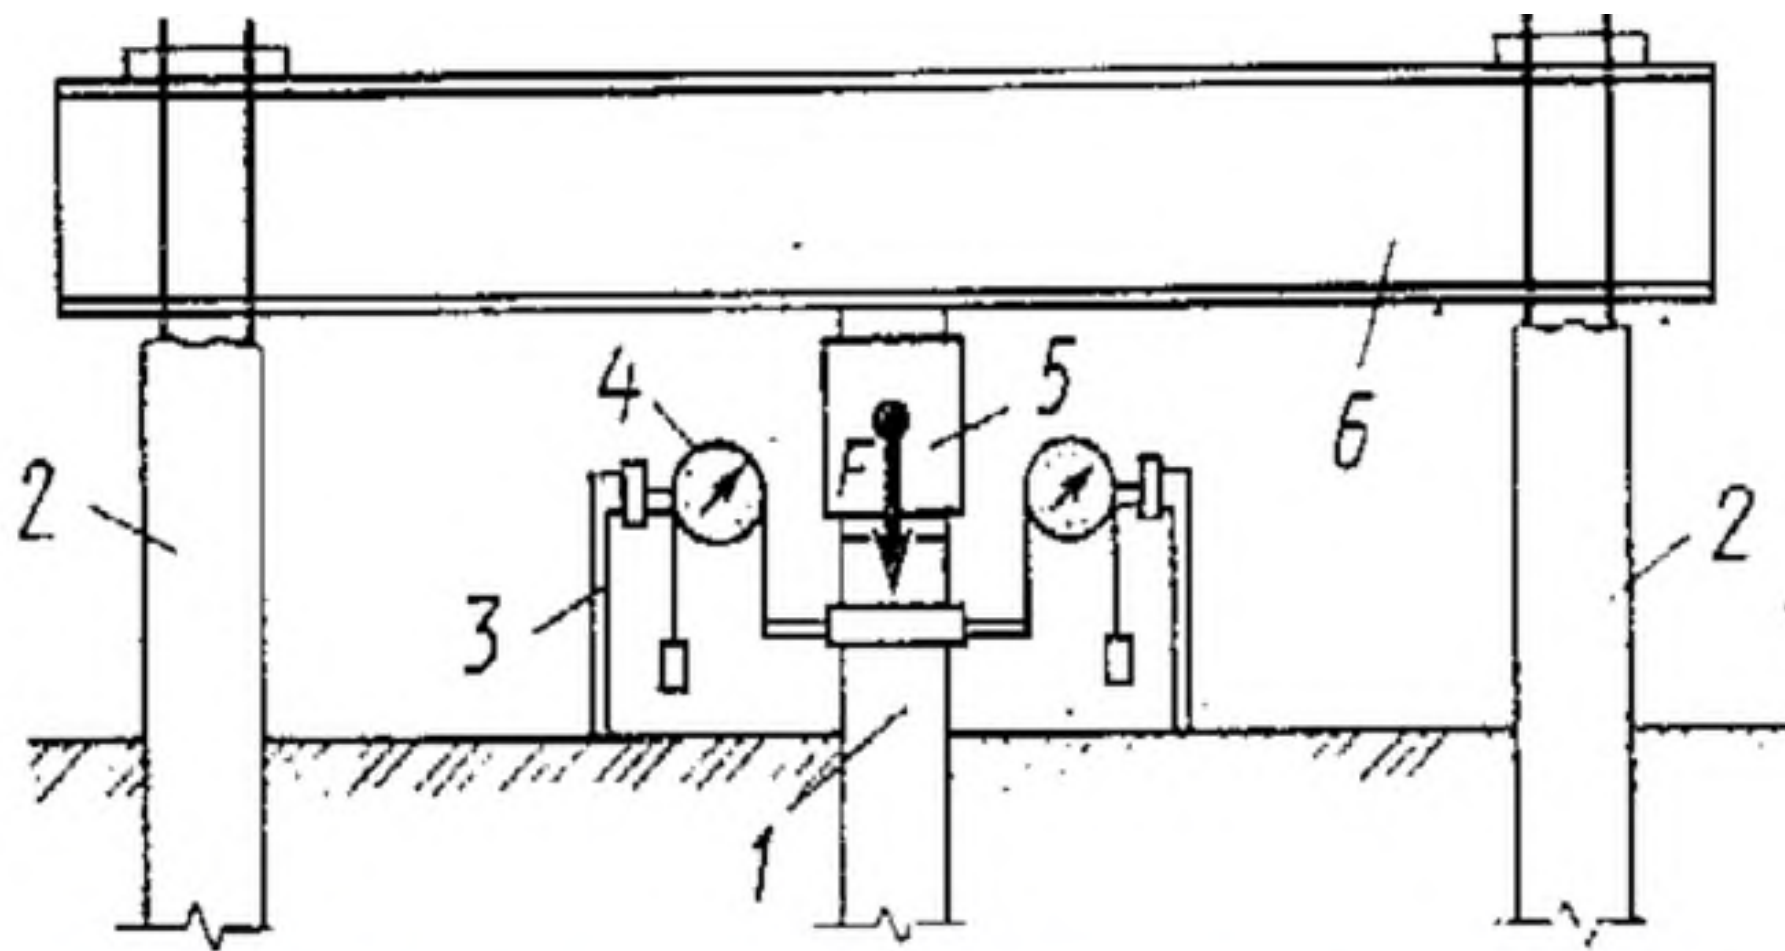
Испытания свай вертикальной статической нагрузкой: 1 - испытываемая свая; 2 - анкерные сваи; 3 - реперная система; 4 - прогибомеры; 5 - домкрат; 6 - упорная балка
